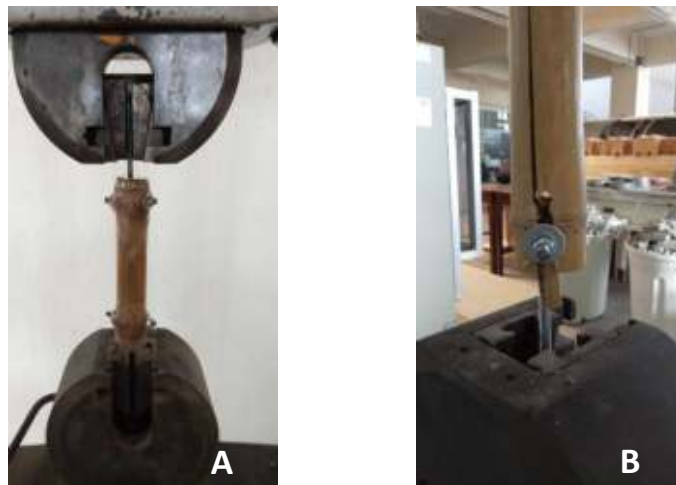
Dispositivo a tracción del dispositivo 5. a) Pieza sin deformación inferior y superior, b) Detalle con deformación inferior, desplazamiento de paredes de culmo.
